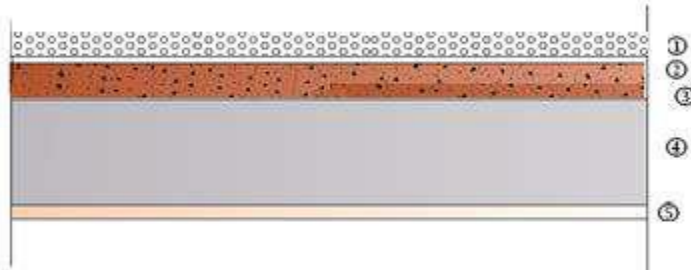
Coupe transversale d'un balcon en dalle pleine.
